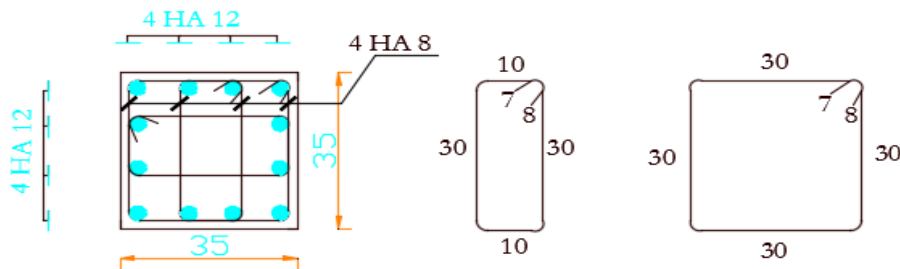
coupe transversale de ferrailage poteaux 35 x 35 cm²
